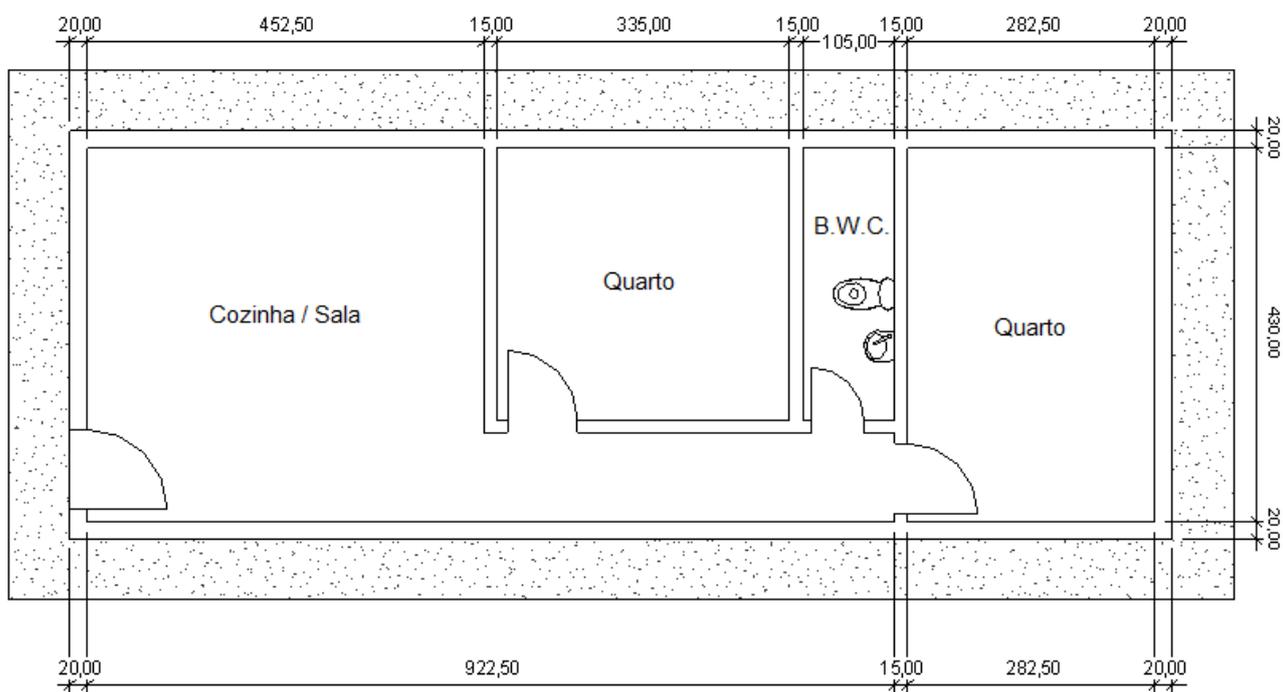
Planta baixa do modelo Fonte: elaborado pelos autores.
